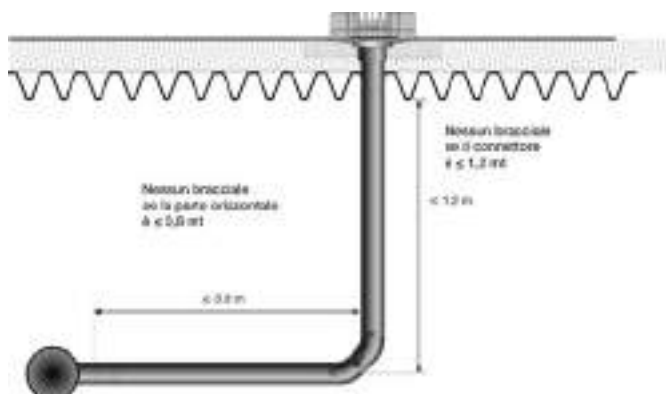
Nessun bracciale verticale se il tubo di scarico verticale $\leq 1,2$ metri.
